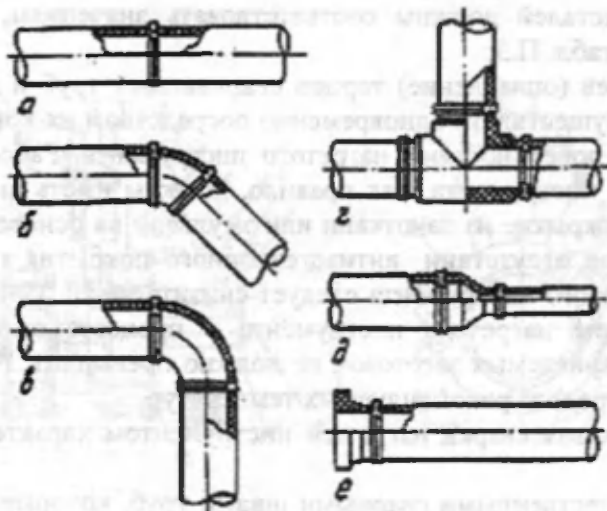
Сварные стыковые соединения труб и соединительных деталей из ПНД:
